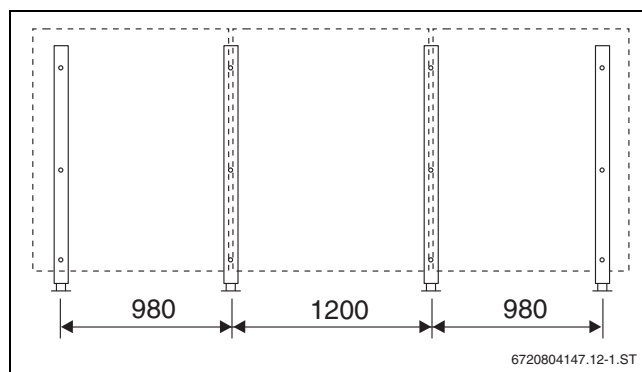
Grundauführung, 3 senkrechte Kollektoren (Maße in mm)
